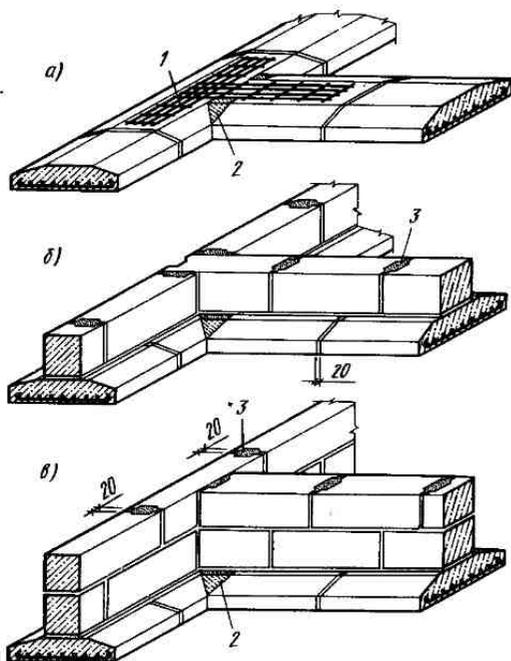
Сопряжение фундаментов продольных и поперечных стен:
